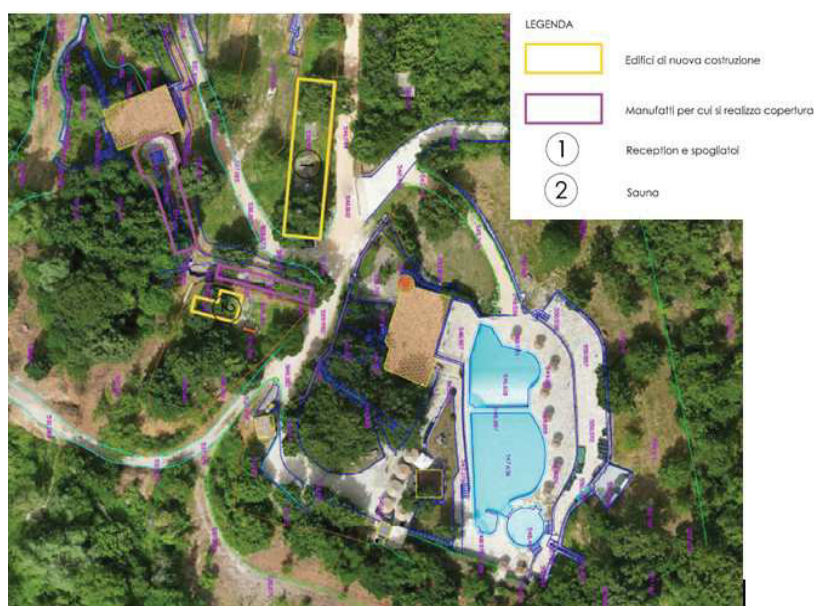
Stralcio pianta progetto con indicazione dei nuovi interventi
